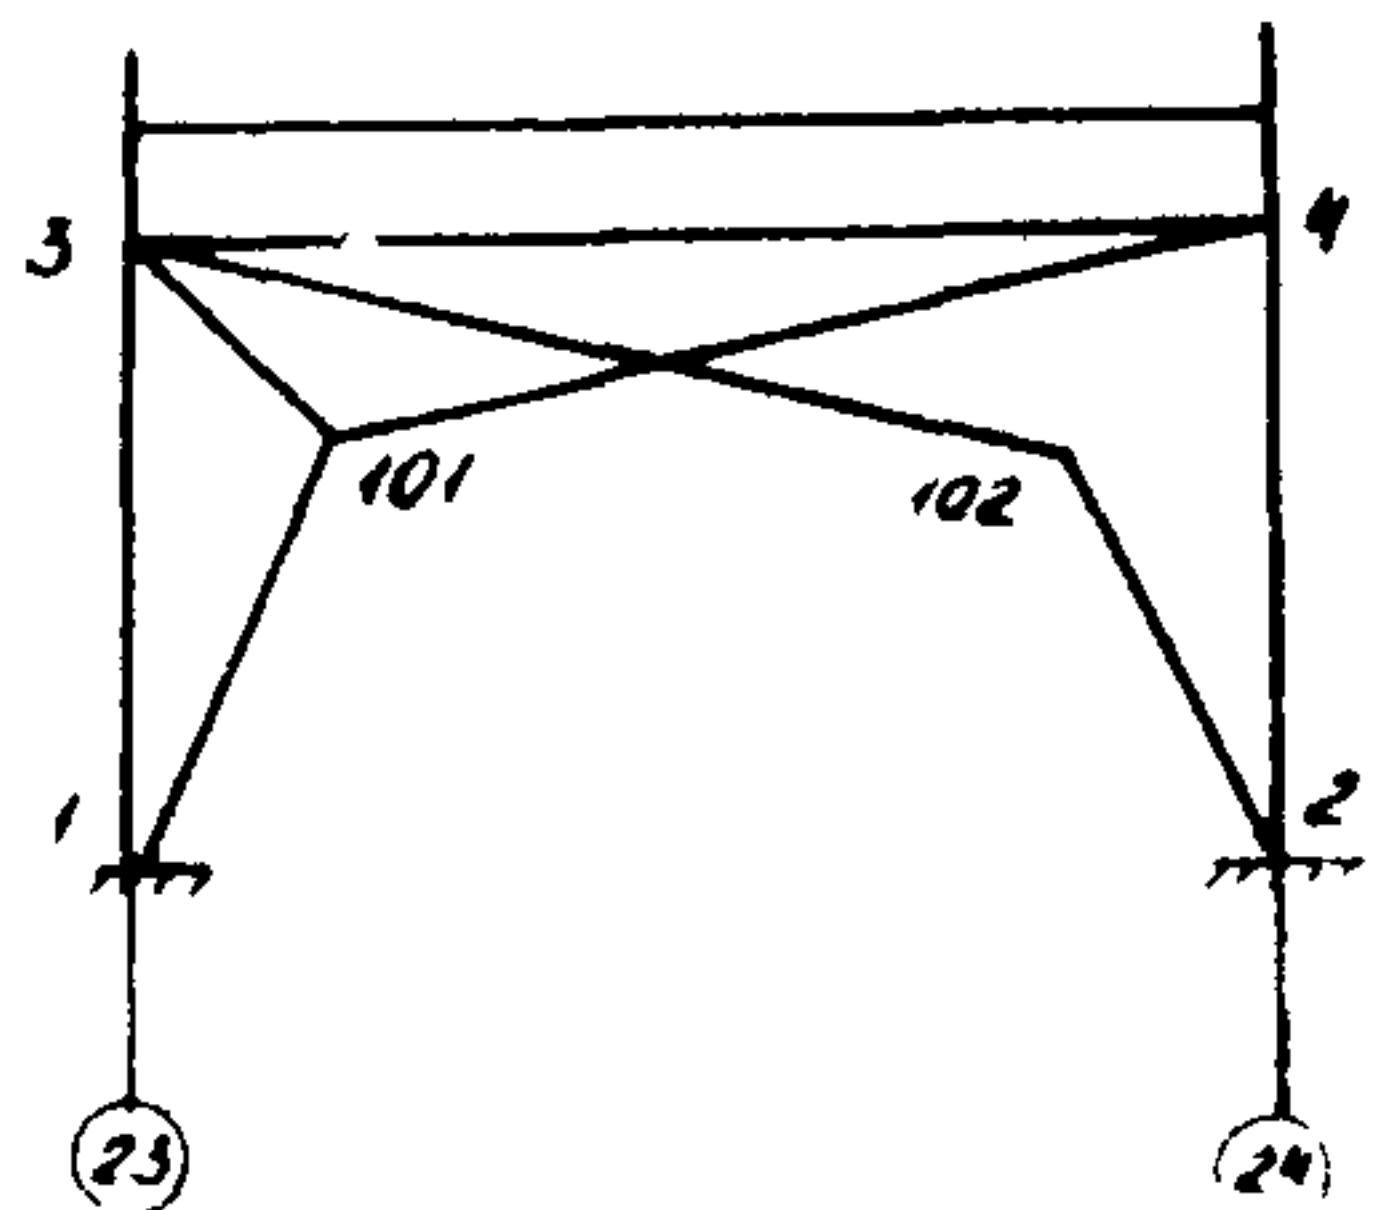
Связь вертикальная между колоннами до подкровельных конструкций (СК)
